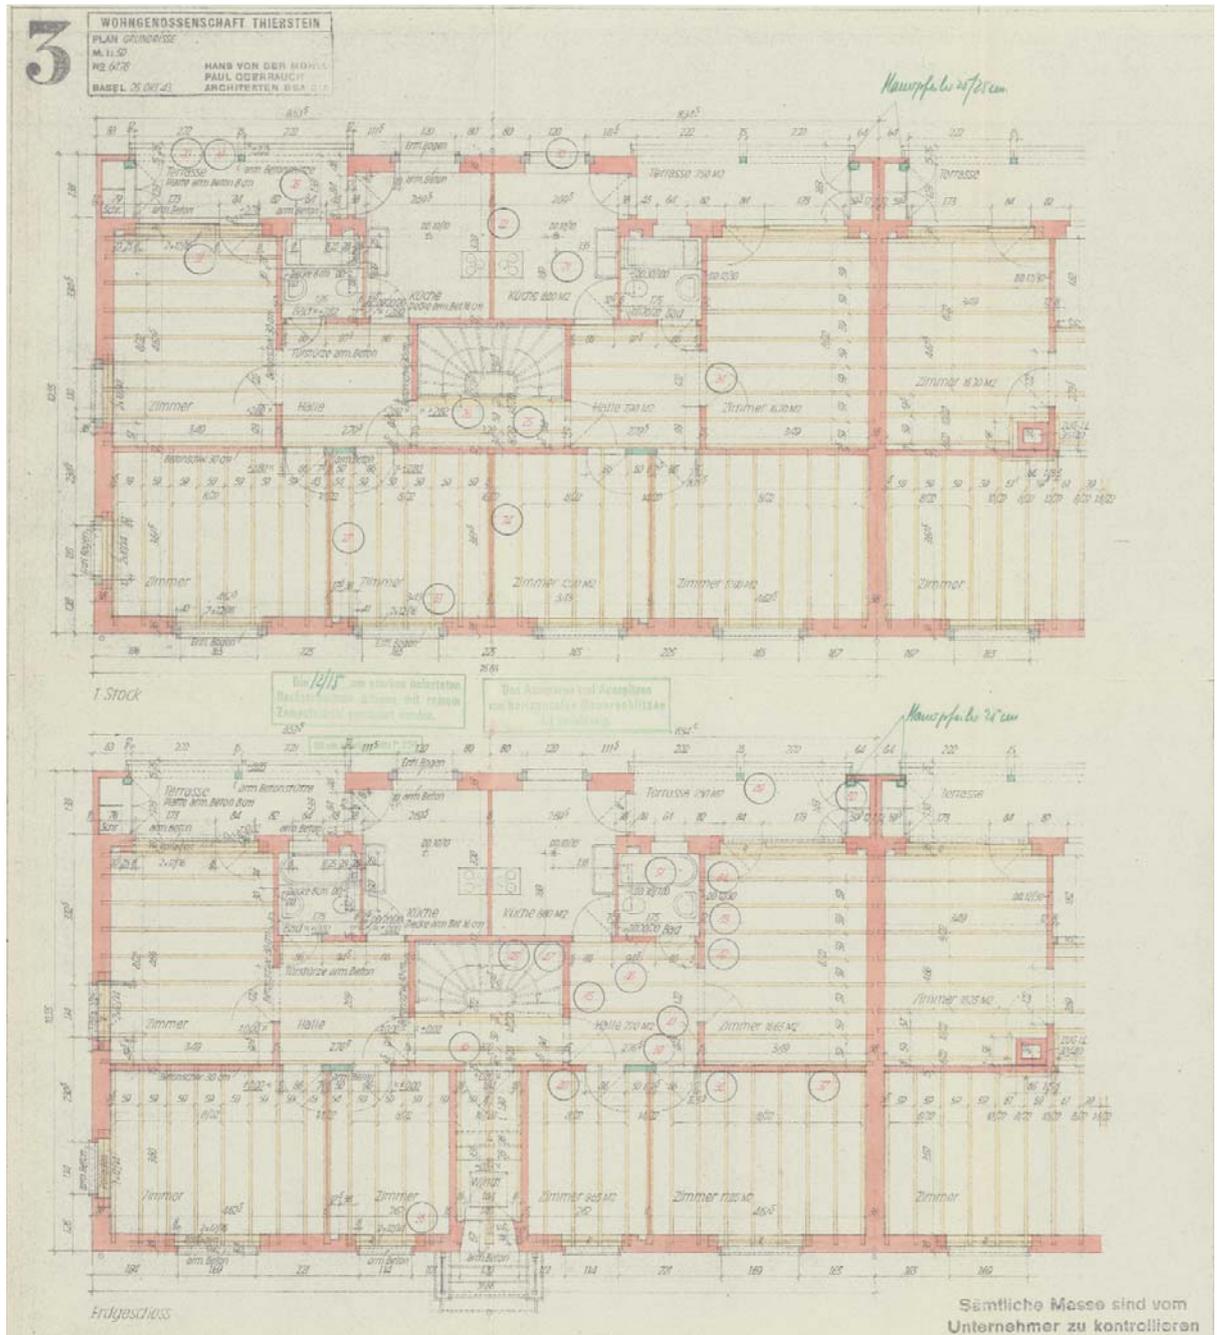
1. Obergeschoss (oben) und Erdgeschoss (unten), Plan 1:50, Etappe 1, 1943 [Quelle: Architekturbüro von der Mühl und Oberrauch, 1943]
